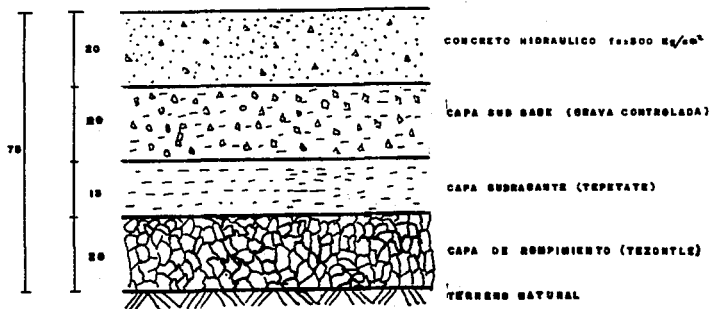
ESTRUCTURA TIPO DEL PAVIMENTO UTILIZADA.
